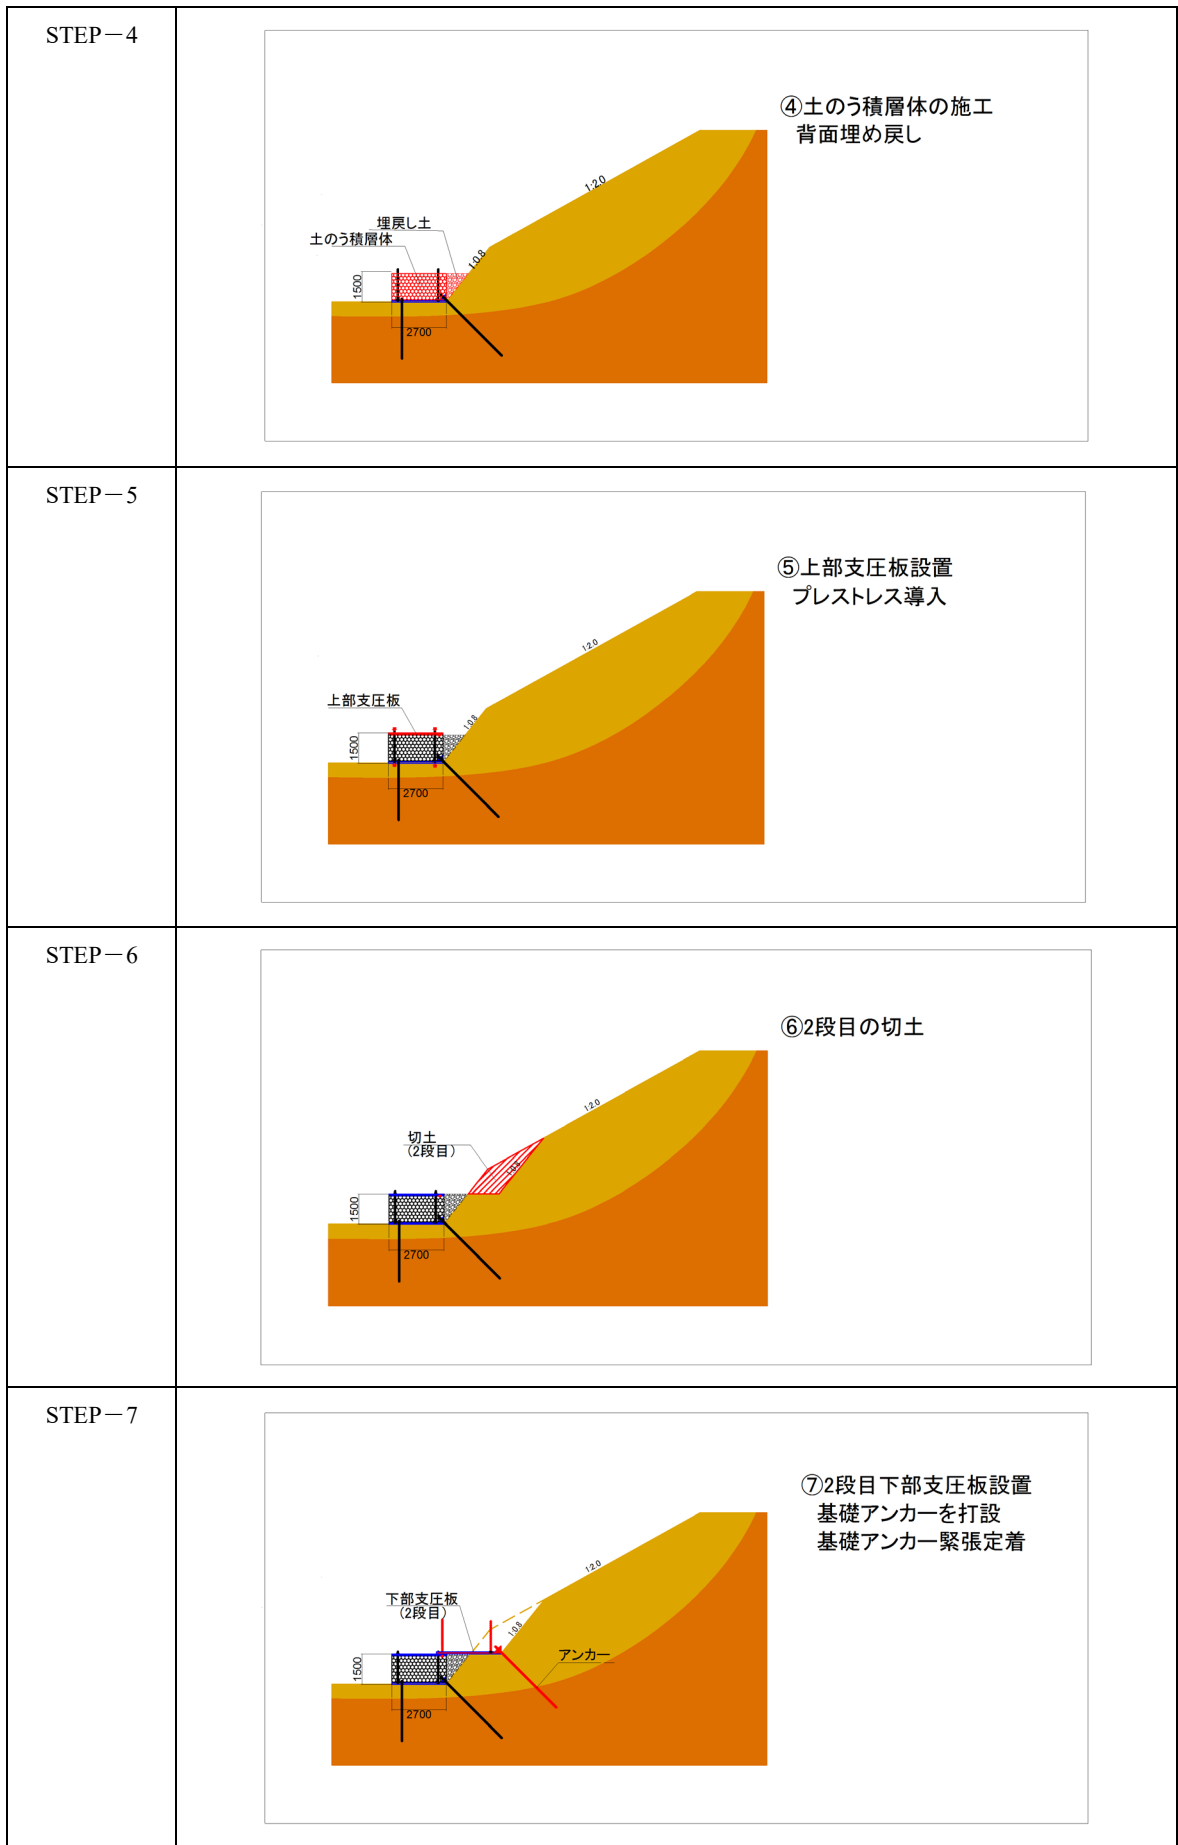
(b) 「多段式」盛土法先補強工法の施工順序図 (その2)
